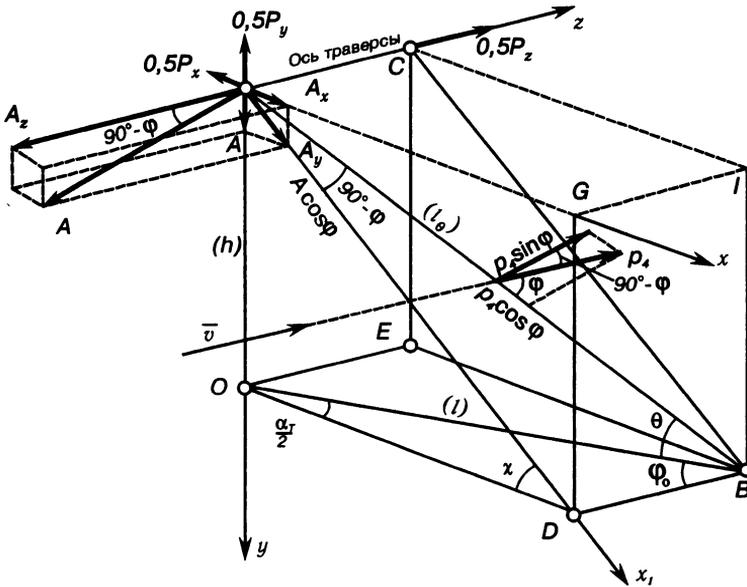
Схема нагрузок от давления ветра на провода, передающихся на угловую опору, расположенную выше соседних опор
